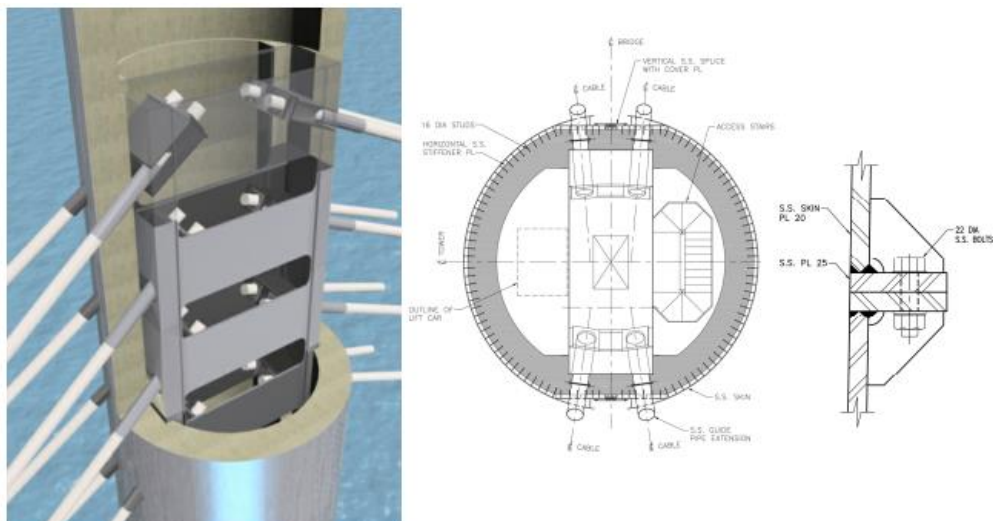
Seção transversal e detalhe típico da coluna da ponte Stonecutters [12]
